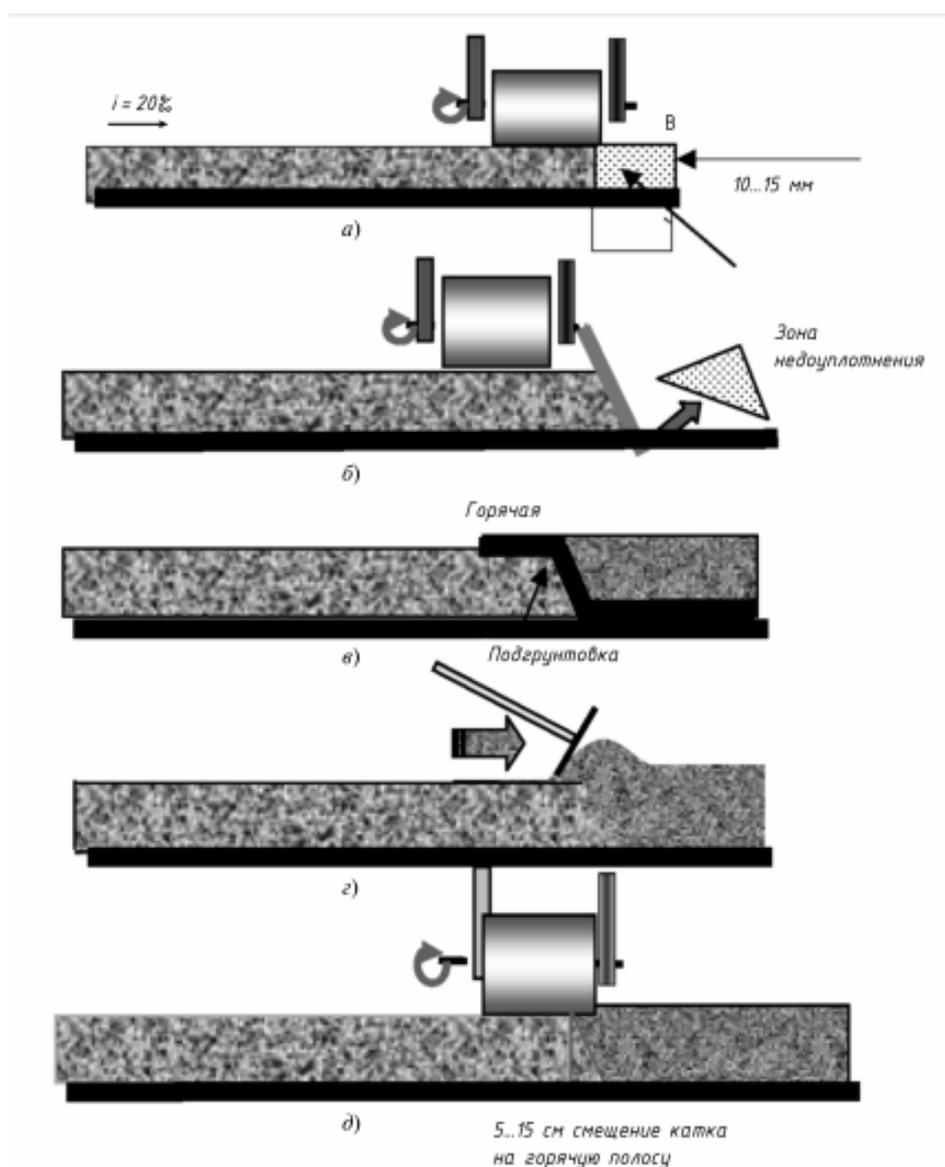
Основные этапы устройства продольного стыка между полосами укладки на асфальтобетонном покрытии с удалением недоуплотненной зоны:
